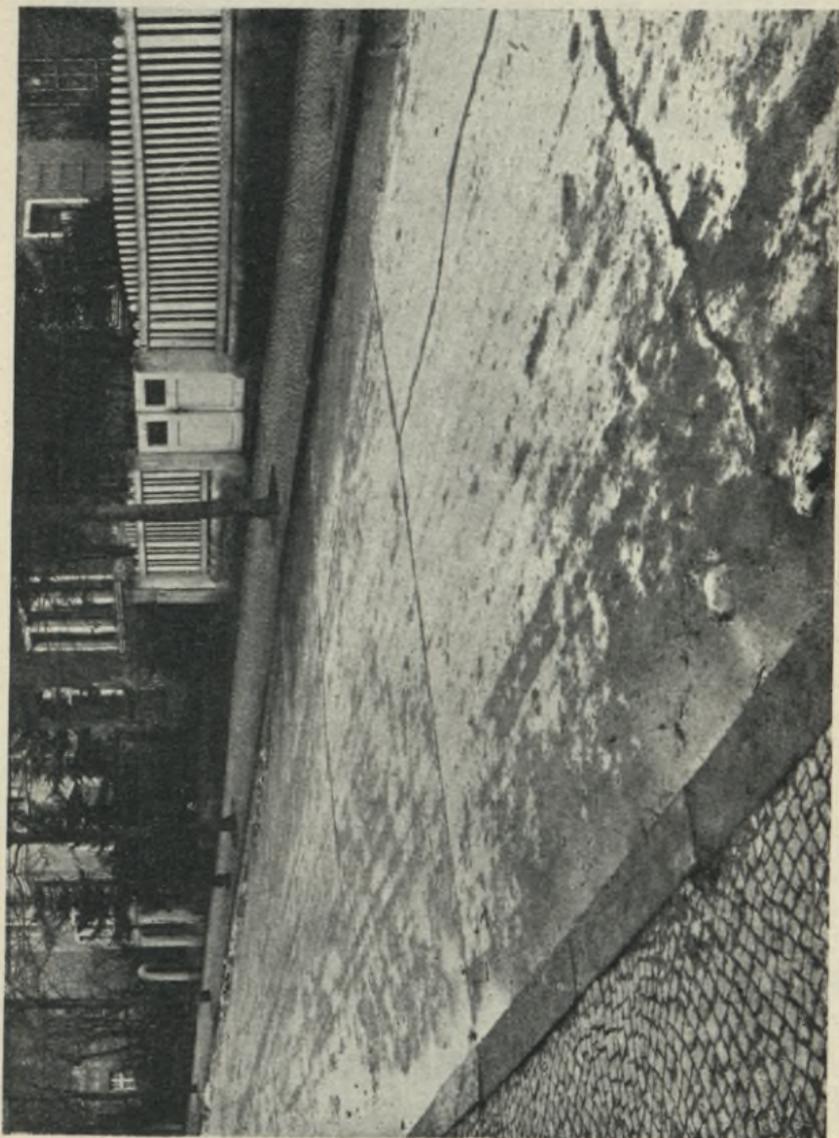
Betonstraße Wiesbaden-Biebrich (1905).
